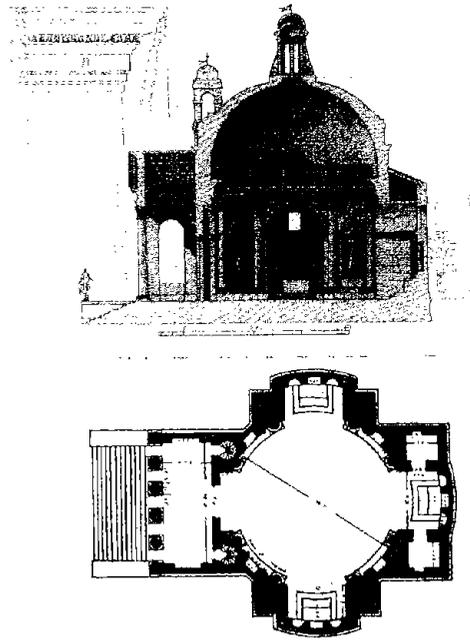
Alzado y planta de la Capilla de la Villa Maser: sección (de Bertoti Scamozzi).
